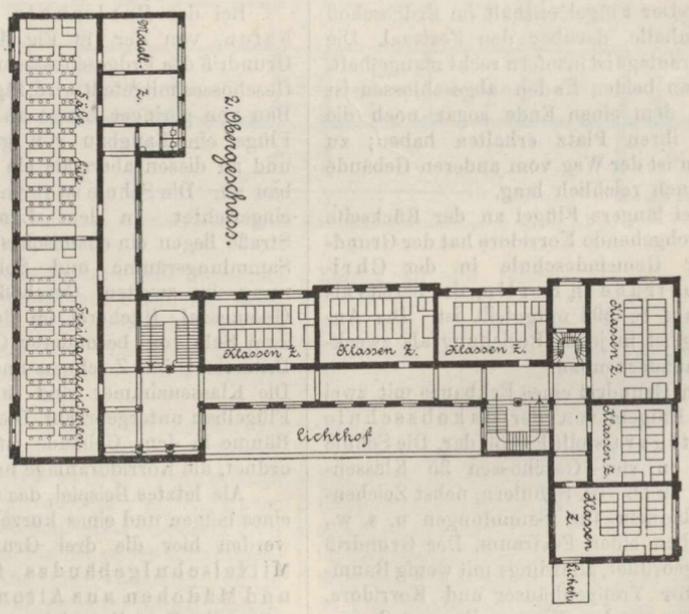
u. 38. Grundrisse von der Schule des Paulsenstifts in Hamburg (s. S. 639).
